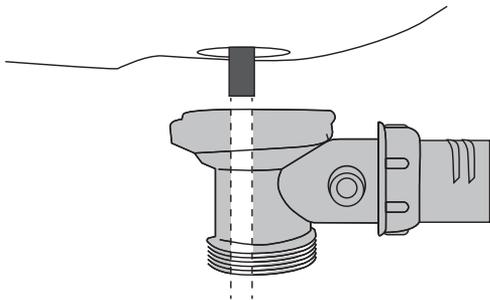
Совмещение крышки корпуса слива со сливным отверстием поддона
